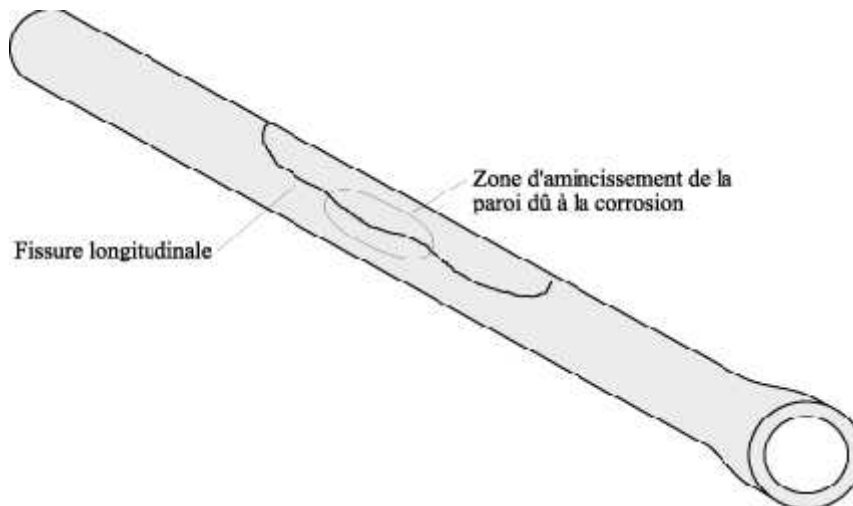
c : Différents types de ruptures des conduites d'eau potable (Fissure longitudinale)
